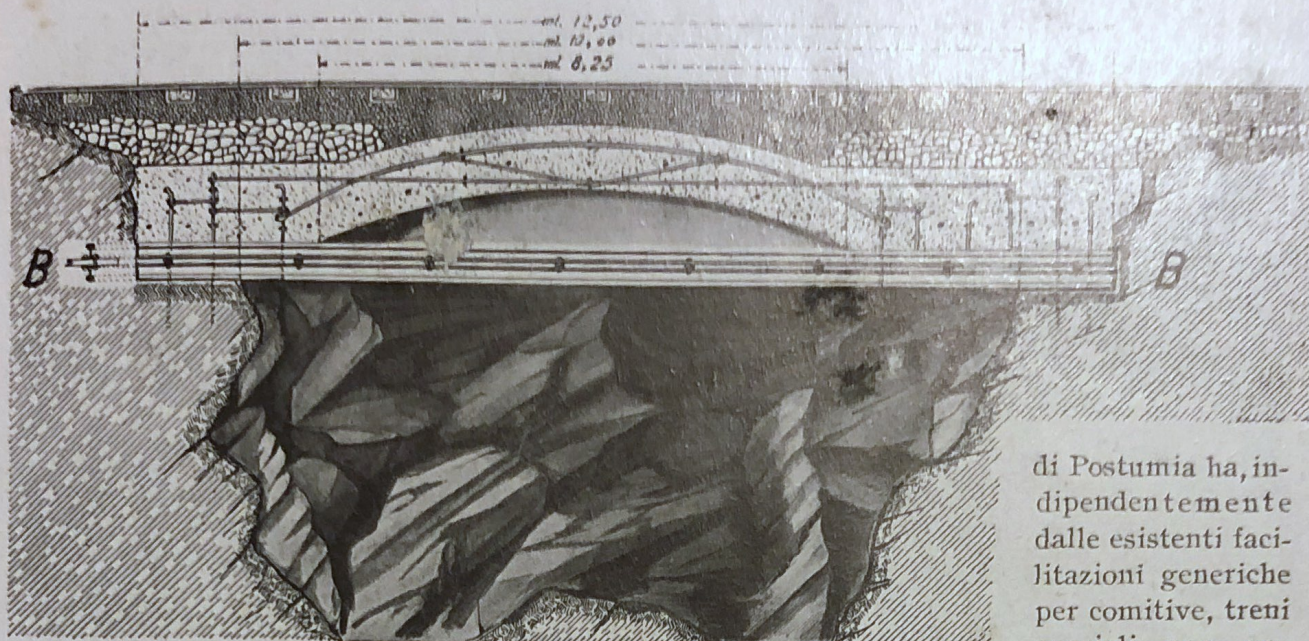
SEZIONE SCHEMATICA DEL PONTE DI CEMENTO ARMATO.
